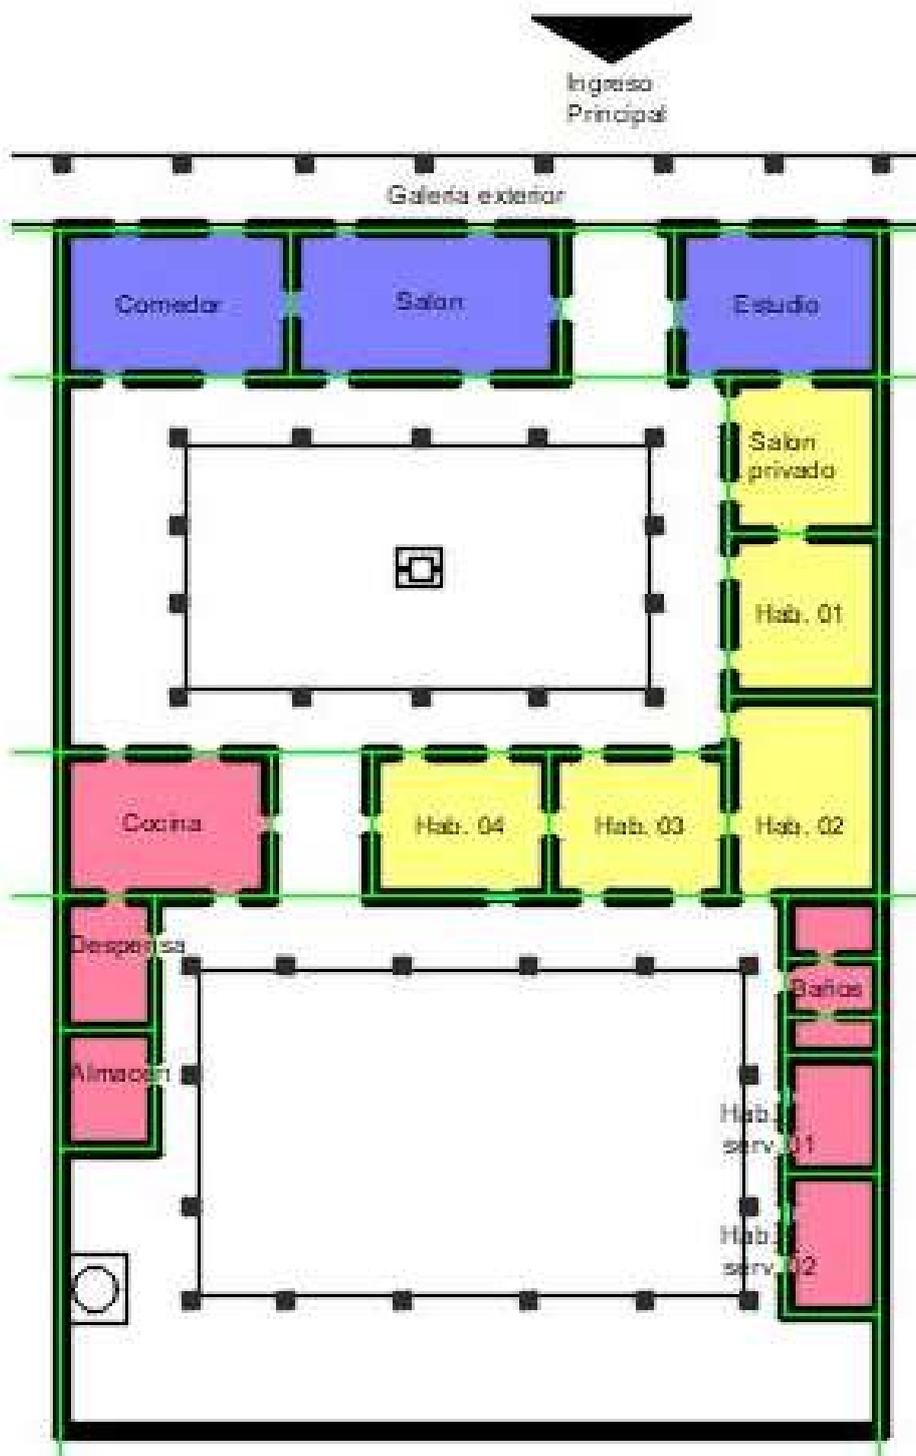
Plano con zonificación. Vivienda tradicional entre medianeras.
